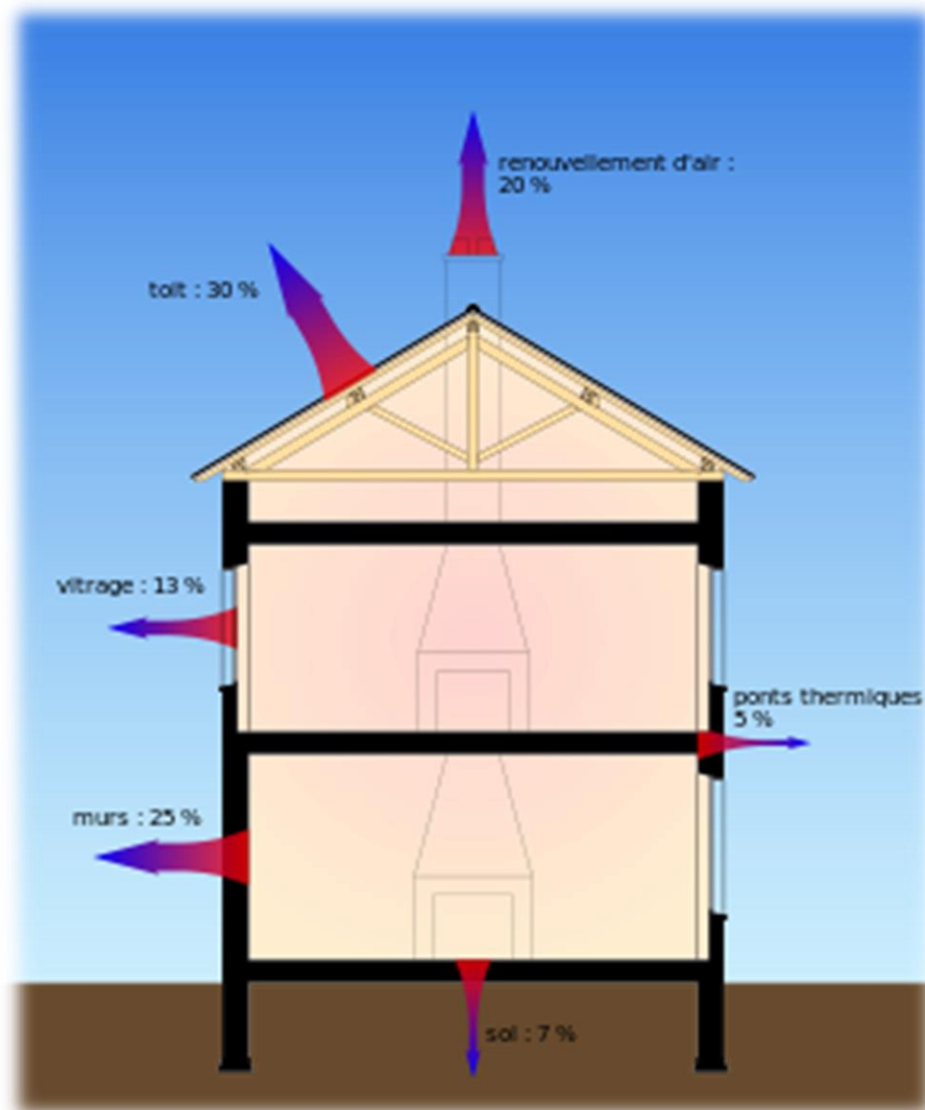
DEPERDITIONS THERMIQUES D'UN BATIMENT.
